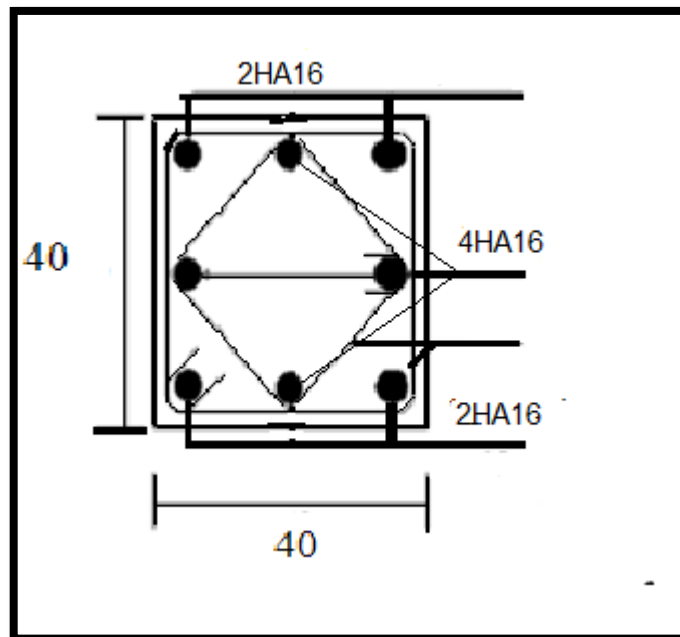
Schéma de ferrailage de poteaux (40\*40)
